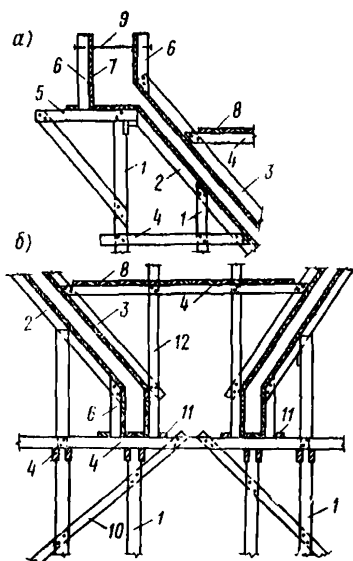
Узлы неинвентарной опалубки железобетонного бункера
